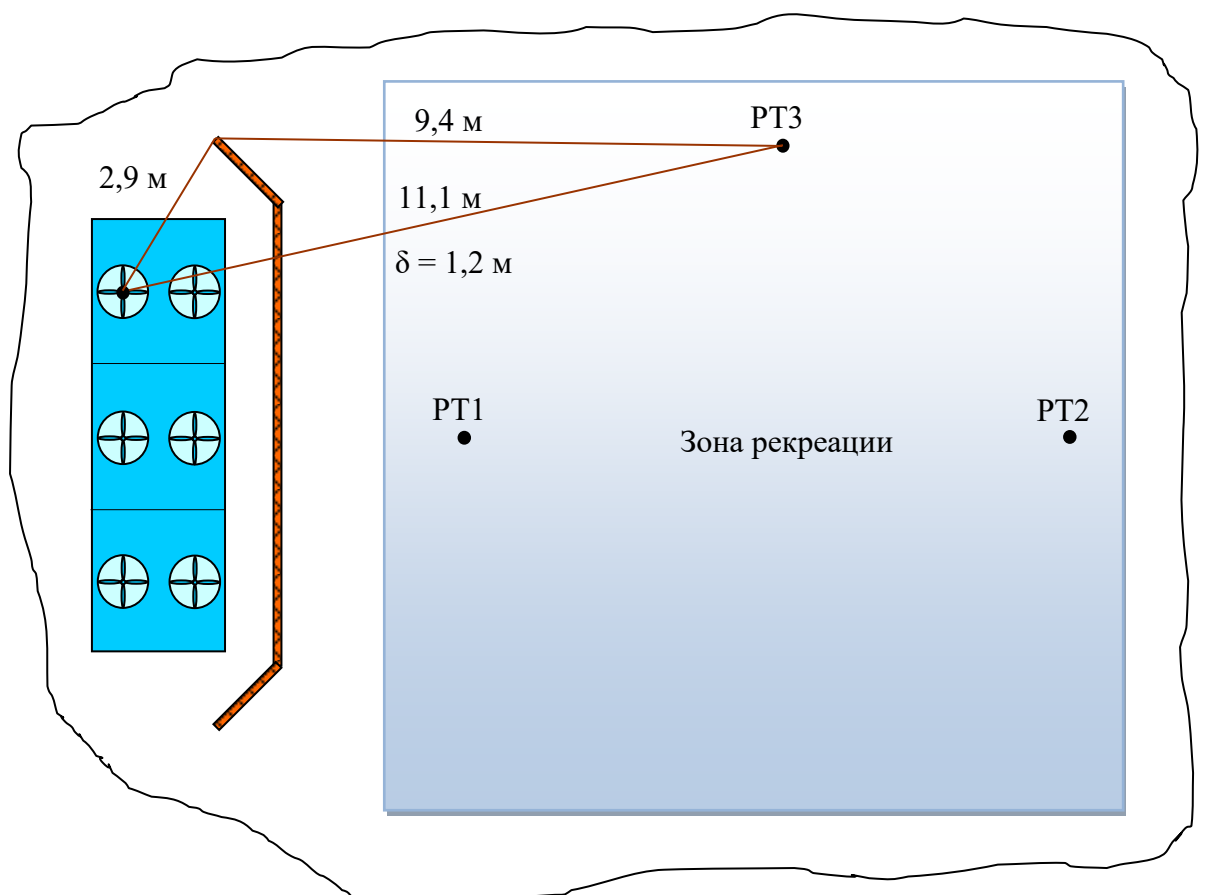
Фрагмент плана кровли здания с воздушным охладителем и рекреационной зоной
